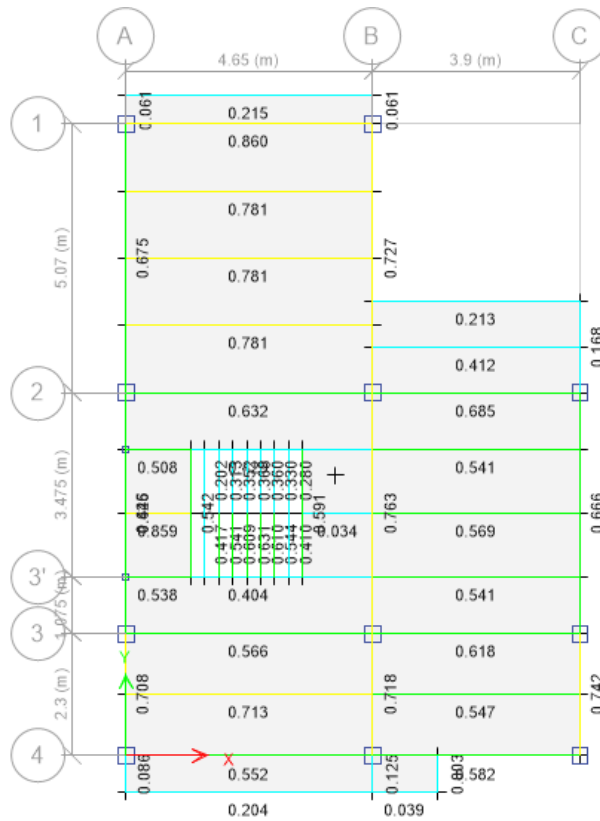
Diseño de vigas principales y secundarias de la losa del nivel +5.94
